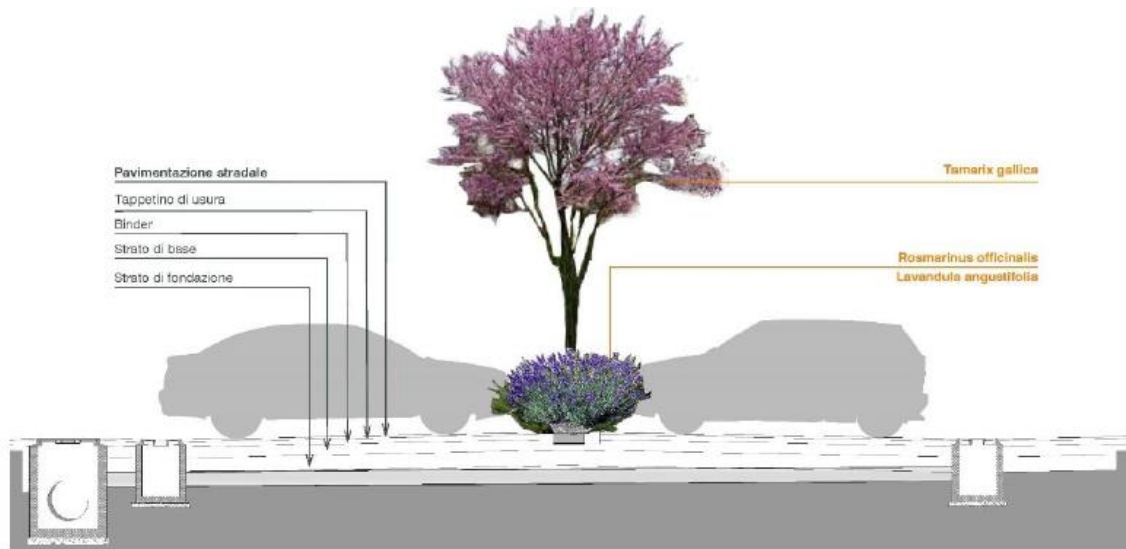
Sistemazione a verde delle aree parcheggio - sezione
